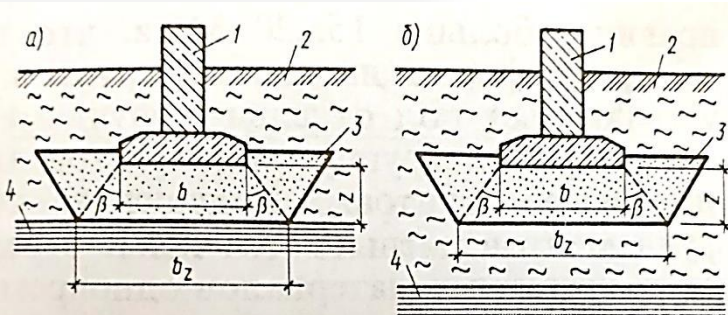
Устройство песчаных подушек при малой (а) и большой (б) толще слабых грунтов:
